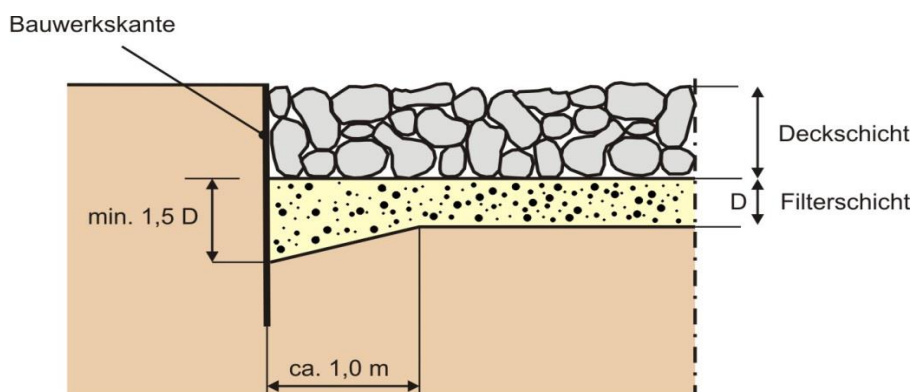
Anschluss eines Deckwerks mit Kornfilter an eine vertikale Bauwerkskante [52]
